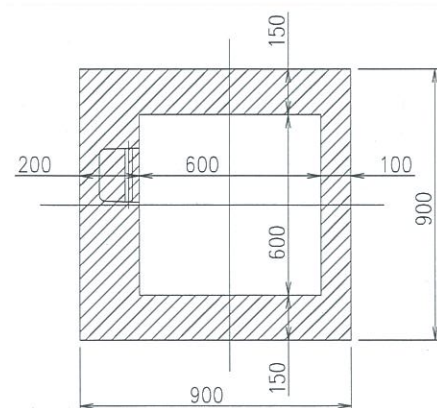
DETAIL VODOMERNEJ ZOSTAVY M 1:10
